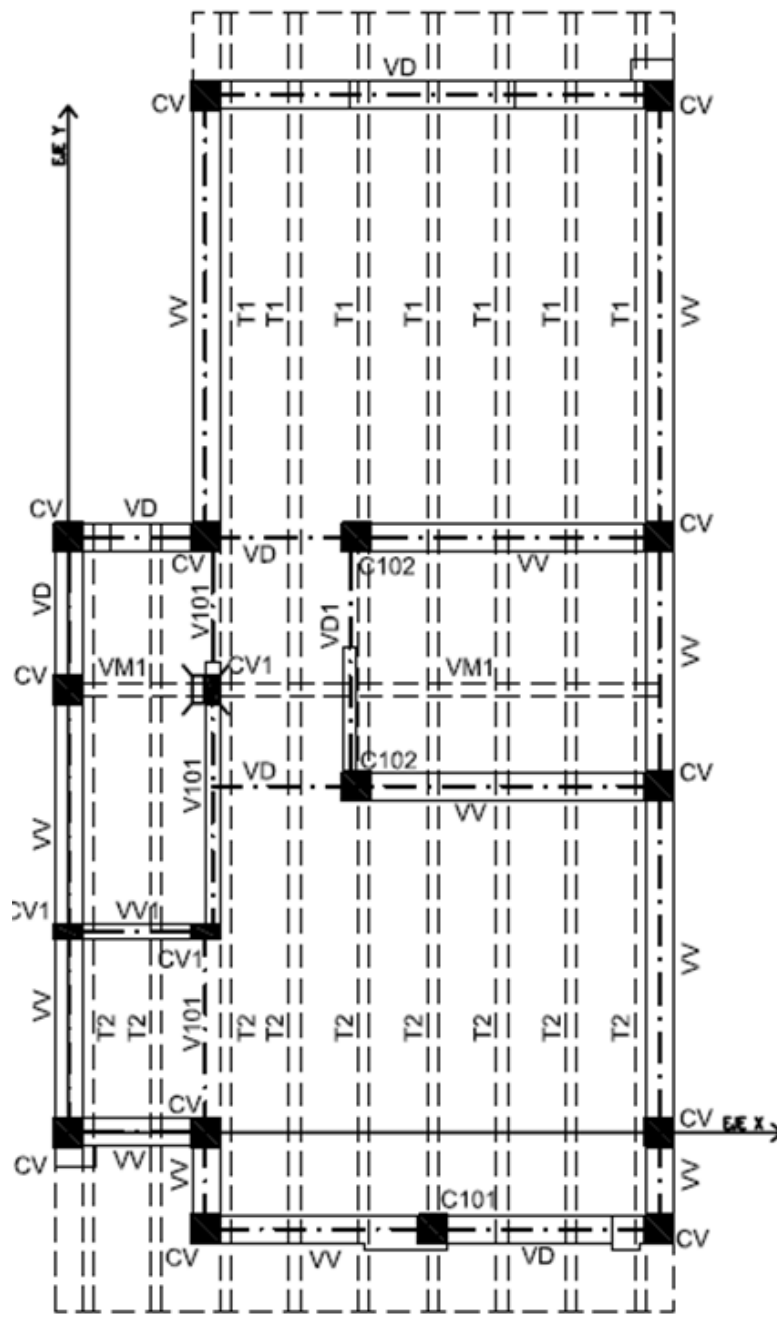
Planta de Estructura de planta alta de la vivienda de dos plantas.
